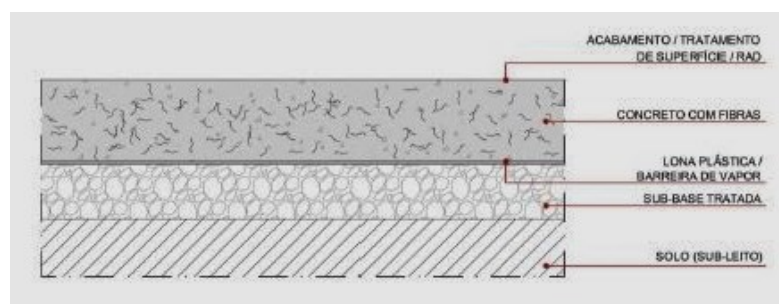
Seção de pavimento de concreto reforçado com fibras
